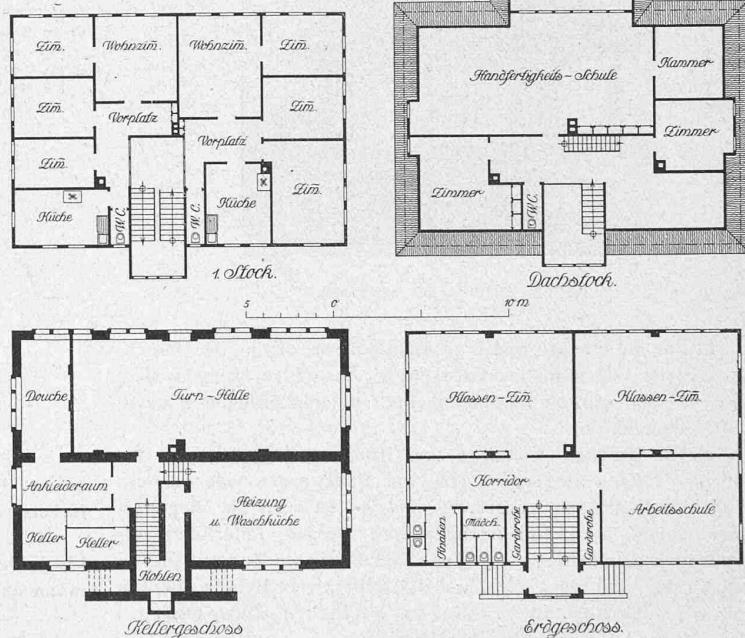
bis 11. Grundrisse zum Schulhaus im „Einfang“. — 1:400.
